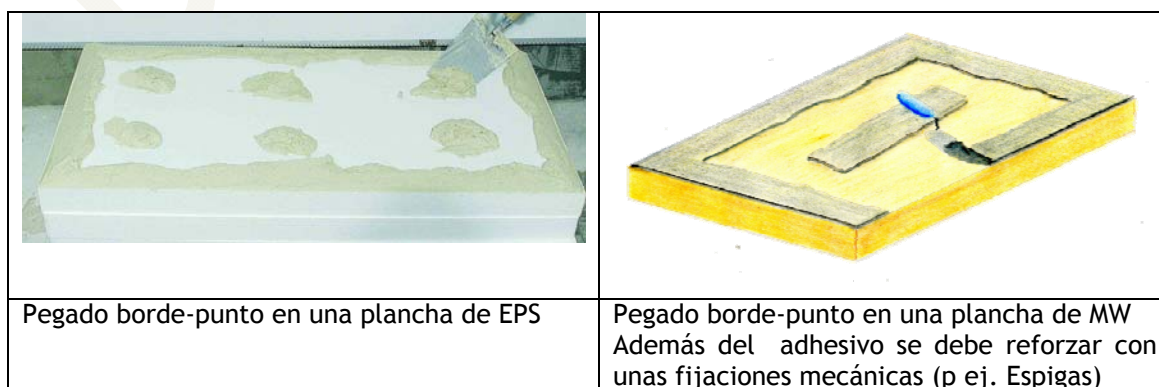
Detalles del pegado borde-punto de las planchas de aislamiento.
